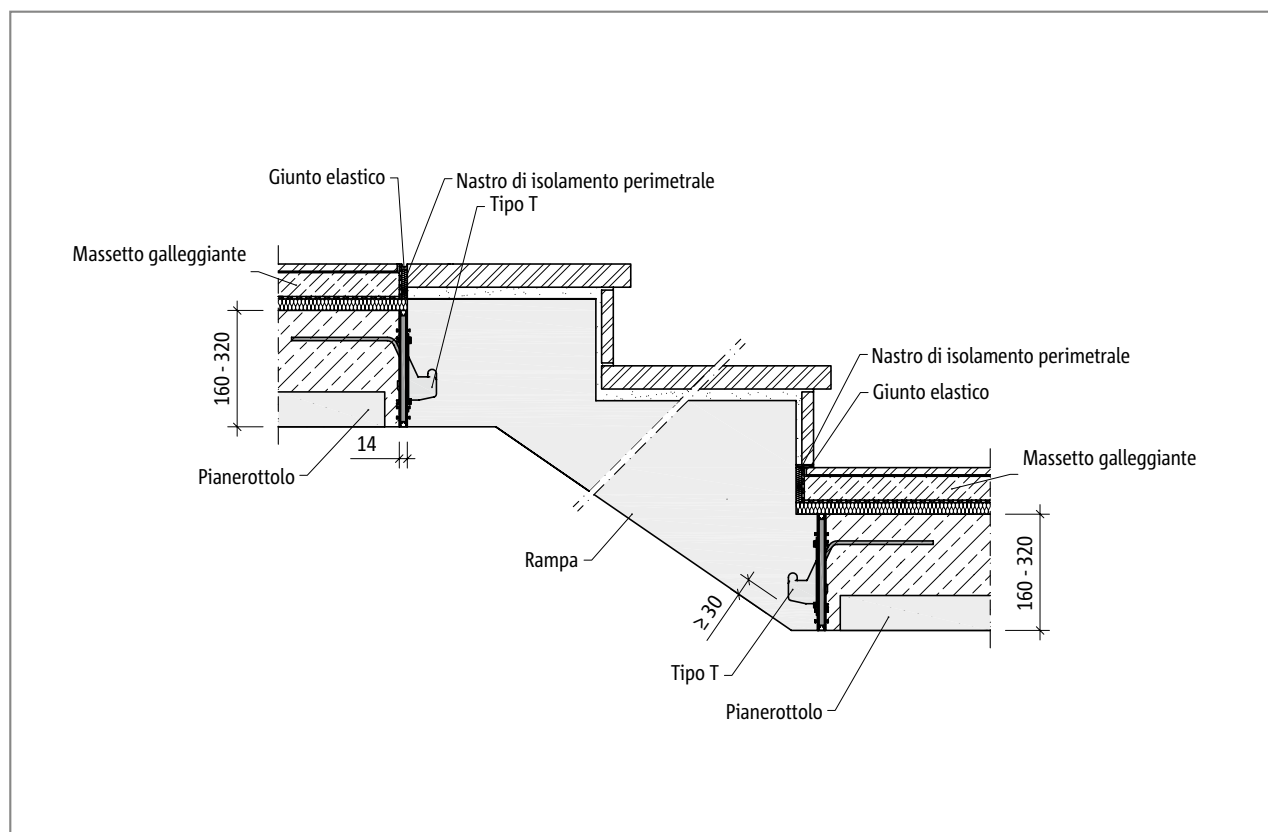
Schöck Tronsole® tipo T: Sezione costruttiva - costruzione prefabbricata
